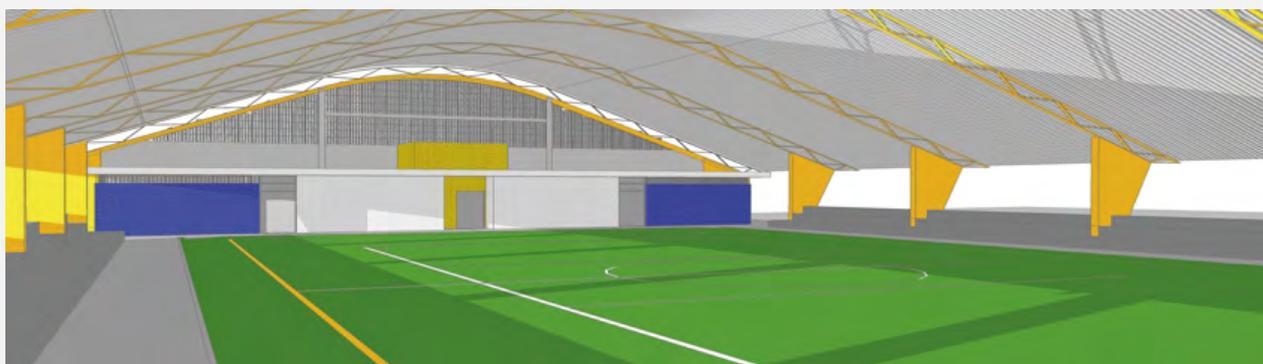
Maquete eletrônica da Quadra coberta com vestiário. Fonte: site do FNDE.
